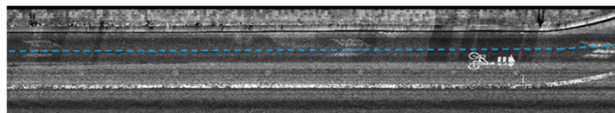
ひび割れ展開図（区間①：国道 54 号）
